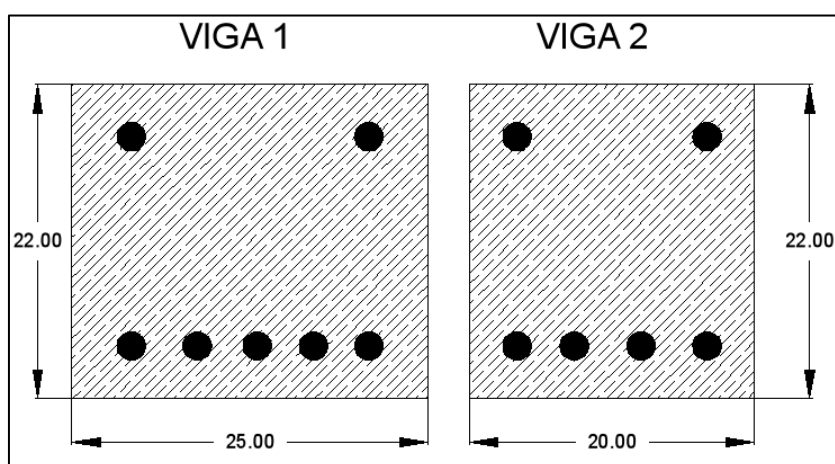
Detalle vigas principales edificio “La Viña”./[cm]
